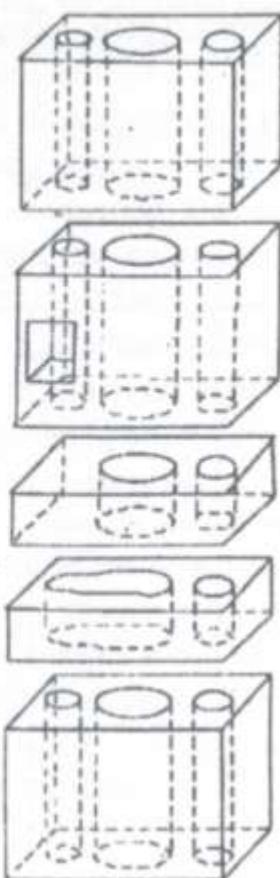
Схема вентиляционного блока для устройства вентиляционных каналов вытяжной системы с вертикальным транзитным каналом и присоединением ответвлений через один этаж
